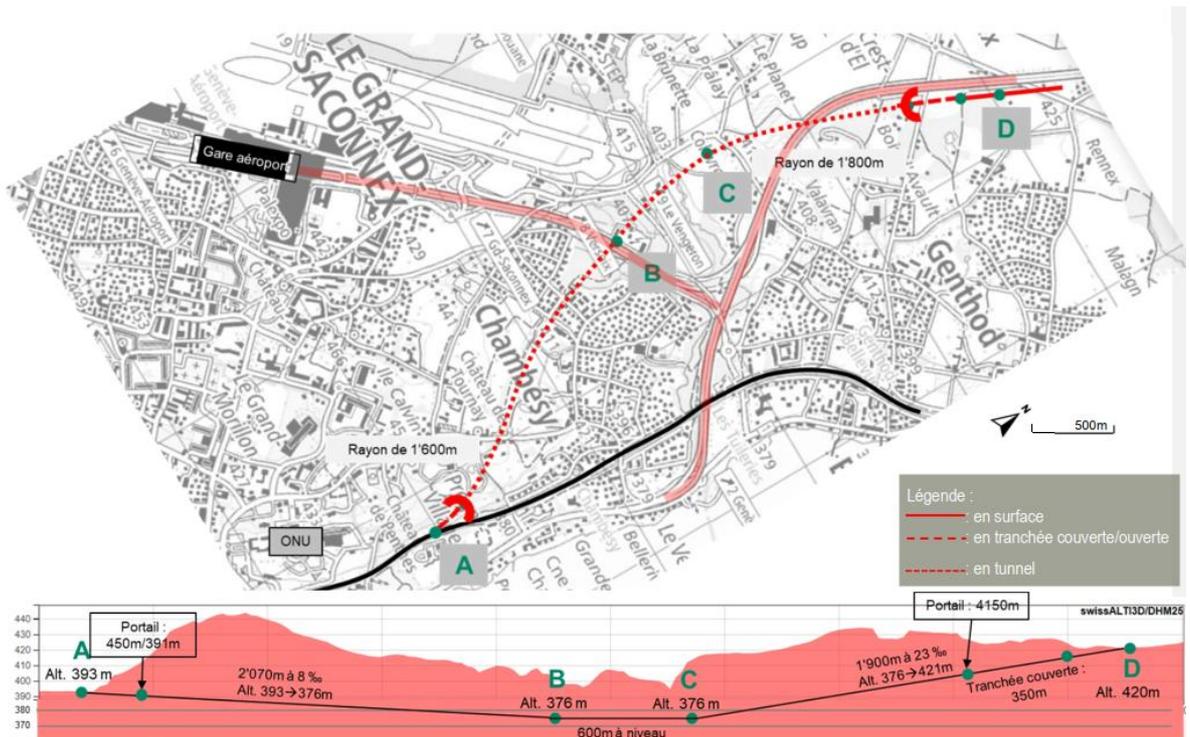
tracé général et profil en long du tunnel du Vengeron
